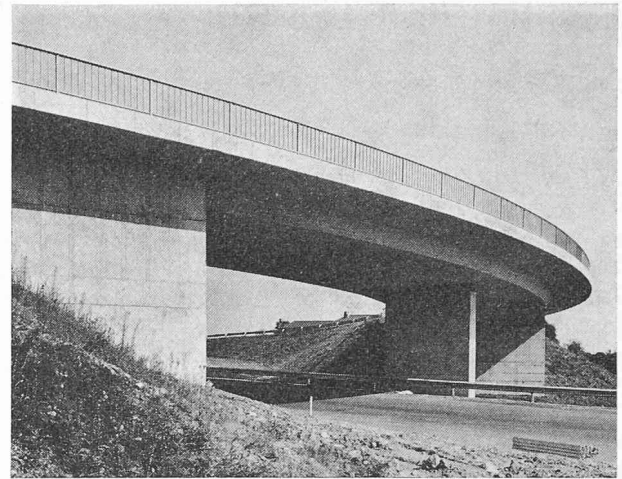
Le pont de Beau-Site, vu au niveau de l'autoroute.
